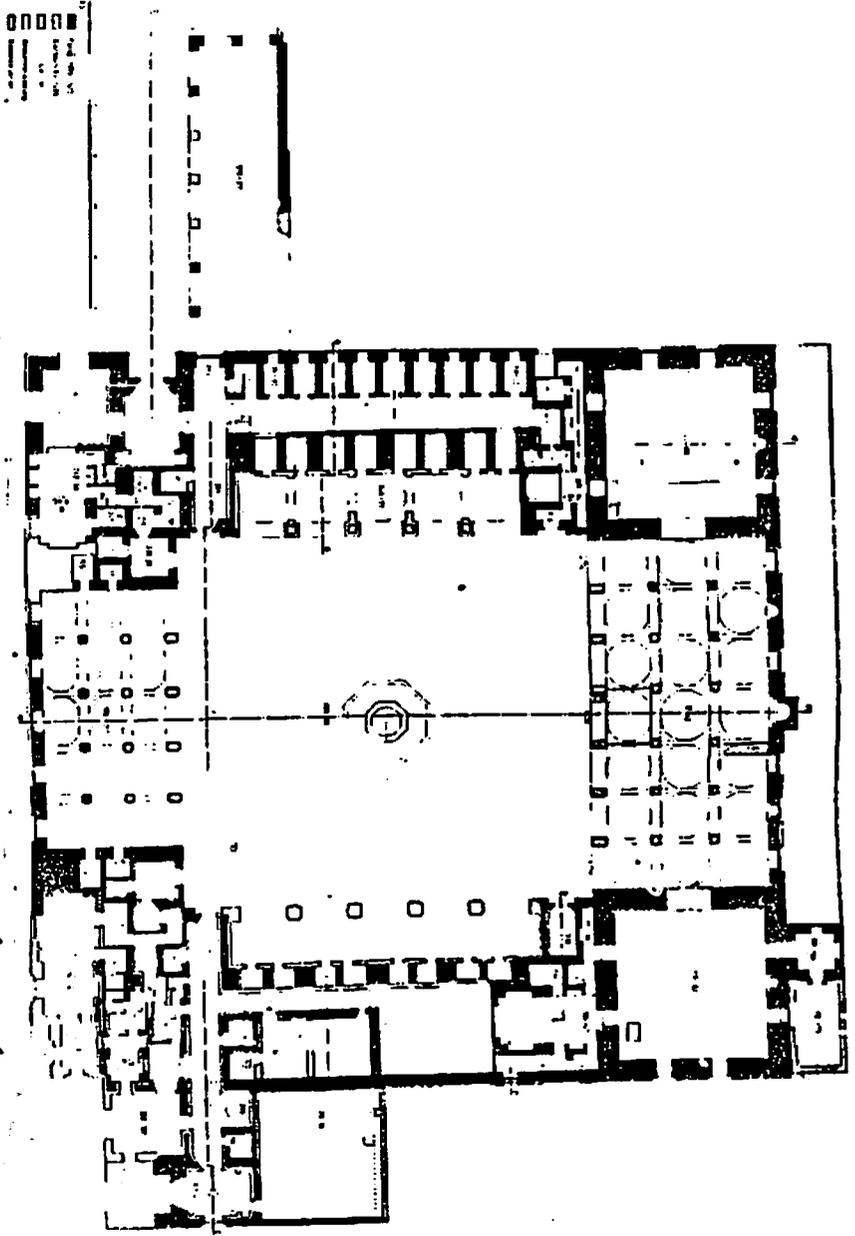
مسقط أفقي لإنشاء السلطان برقوق بالنحاسين . عن هيئة الآثار
